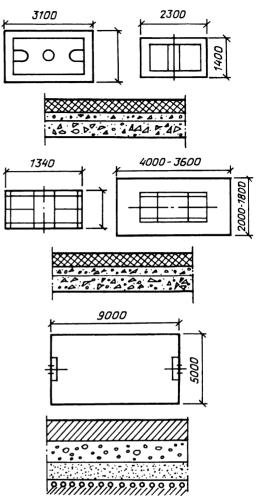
Схемы покрытий игровых, спортивных и других площадок
